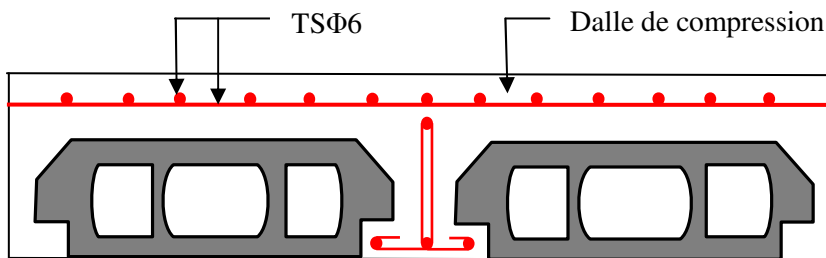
Schéma de ferrailage de la dalle de compression.
